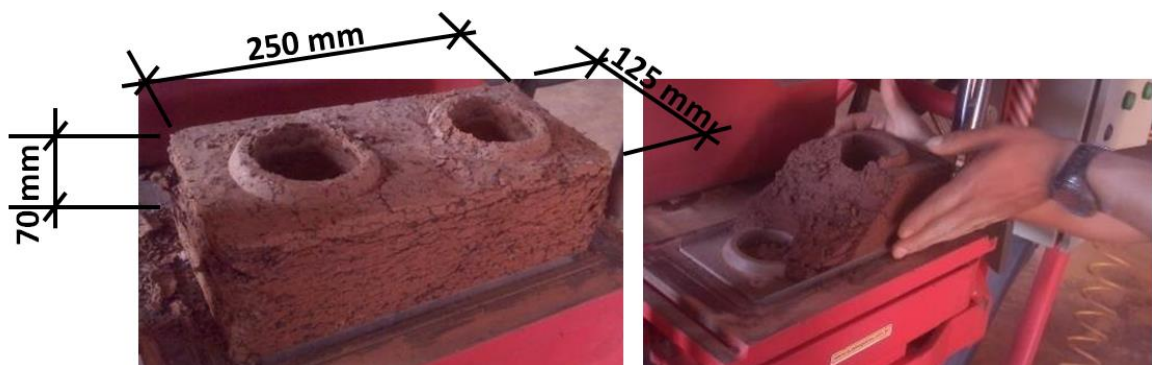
Moldagem do tijolo do equipamento hidráulico.
